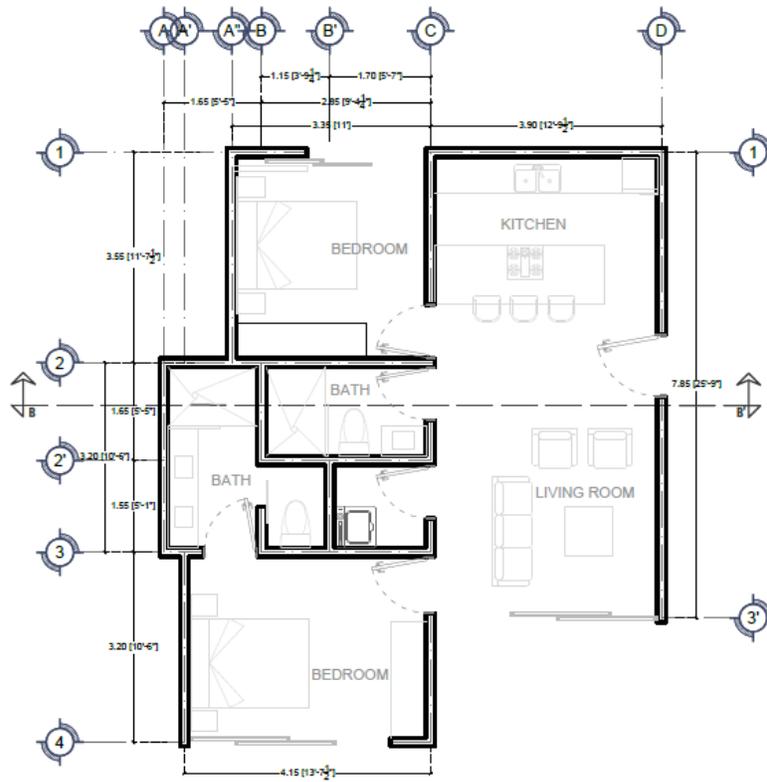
Planta arquitectónica del departamento tipo del Edificio 2.
